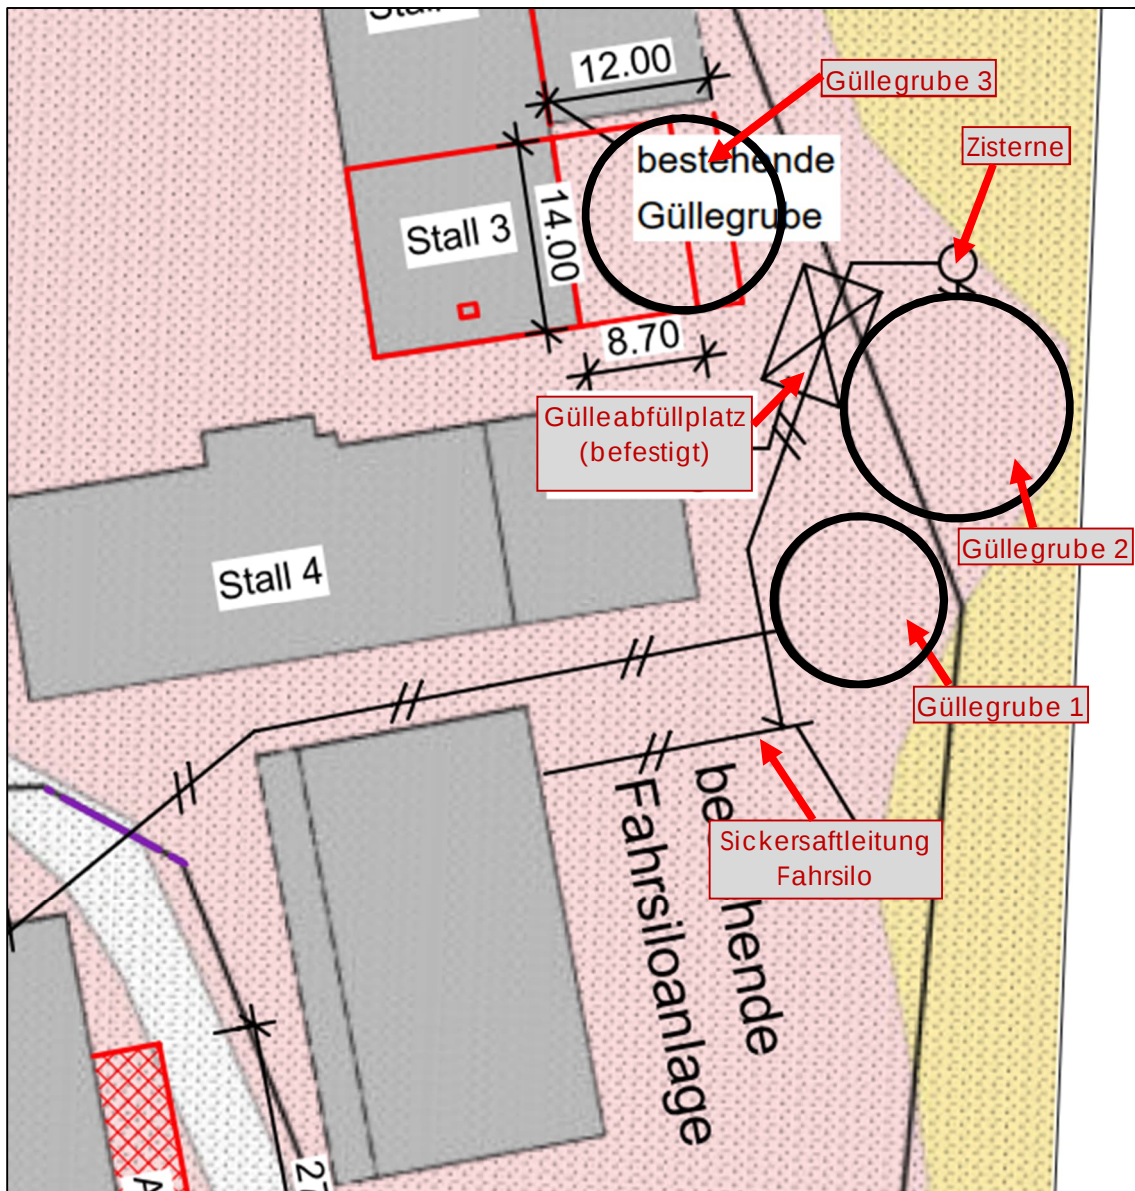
Lageplan mit Darstellung des Gülleabfüllplatzes sowie der Sickersaftleitung des Fahrlo (Quelle Lageplan: BBV Landsiedlung GmbH)
